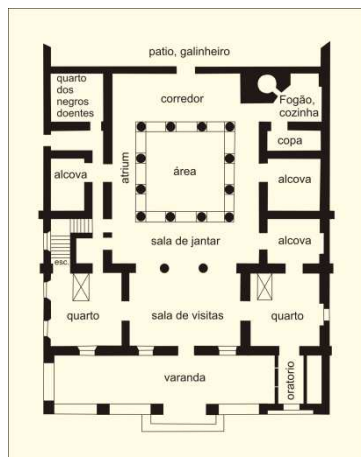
Planta de uma casa de chácara, desenhada por Debret
